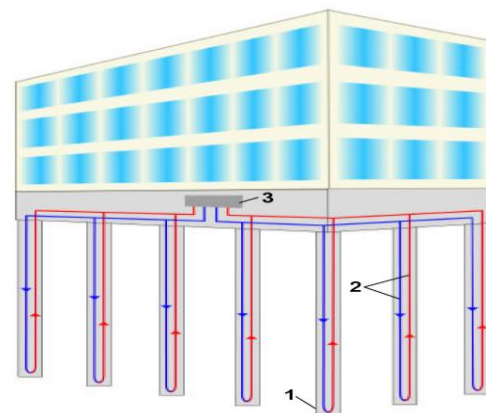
Schéma d'un bâtiment fondé sur pieux.
